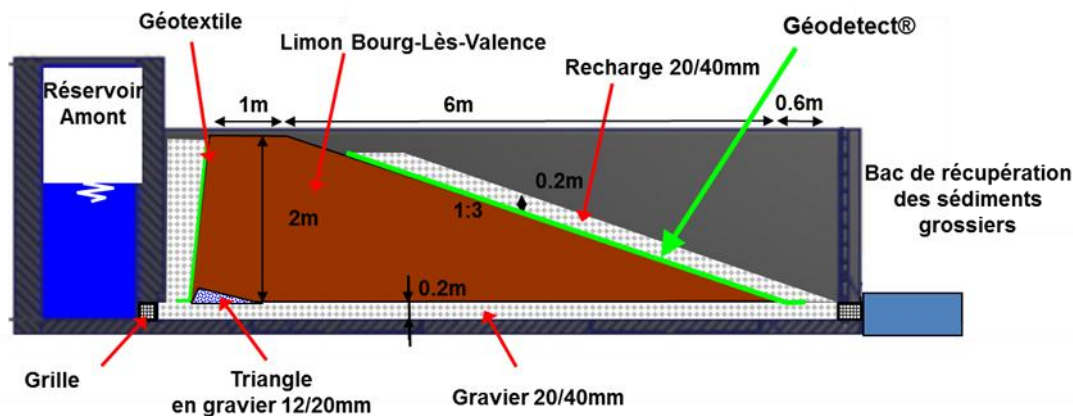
Schéma de l'ouvrage 8 avec un géotextile sous la recharge.
